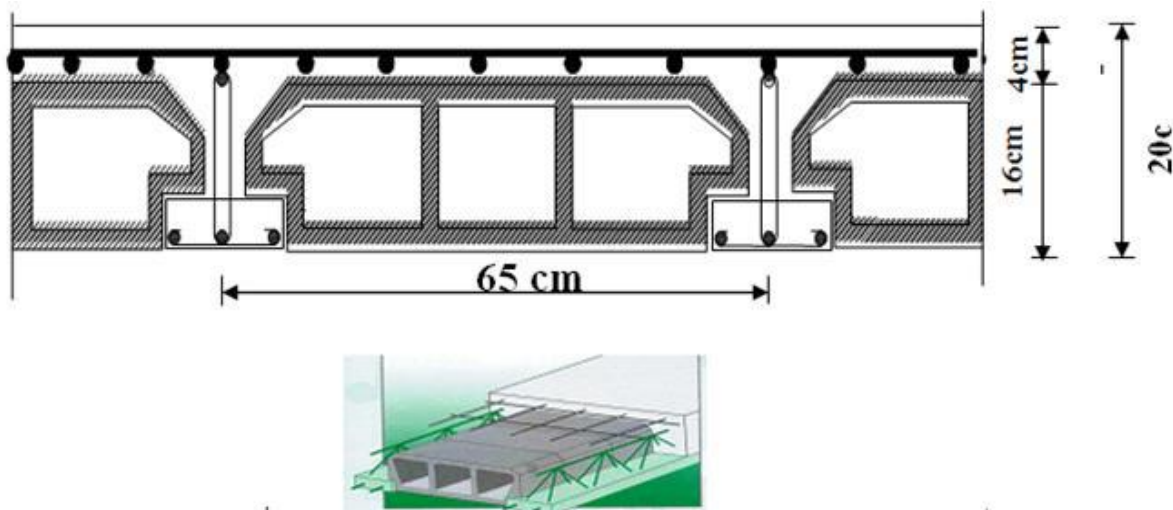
Schéma descriptif d'un plancher en corps creux.
